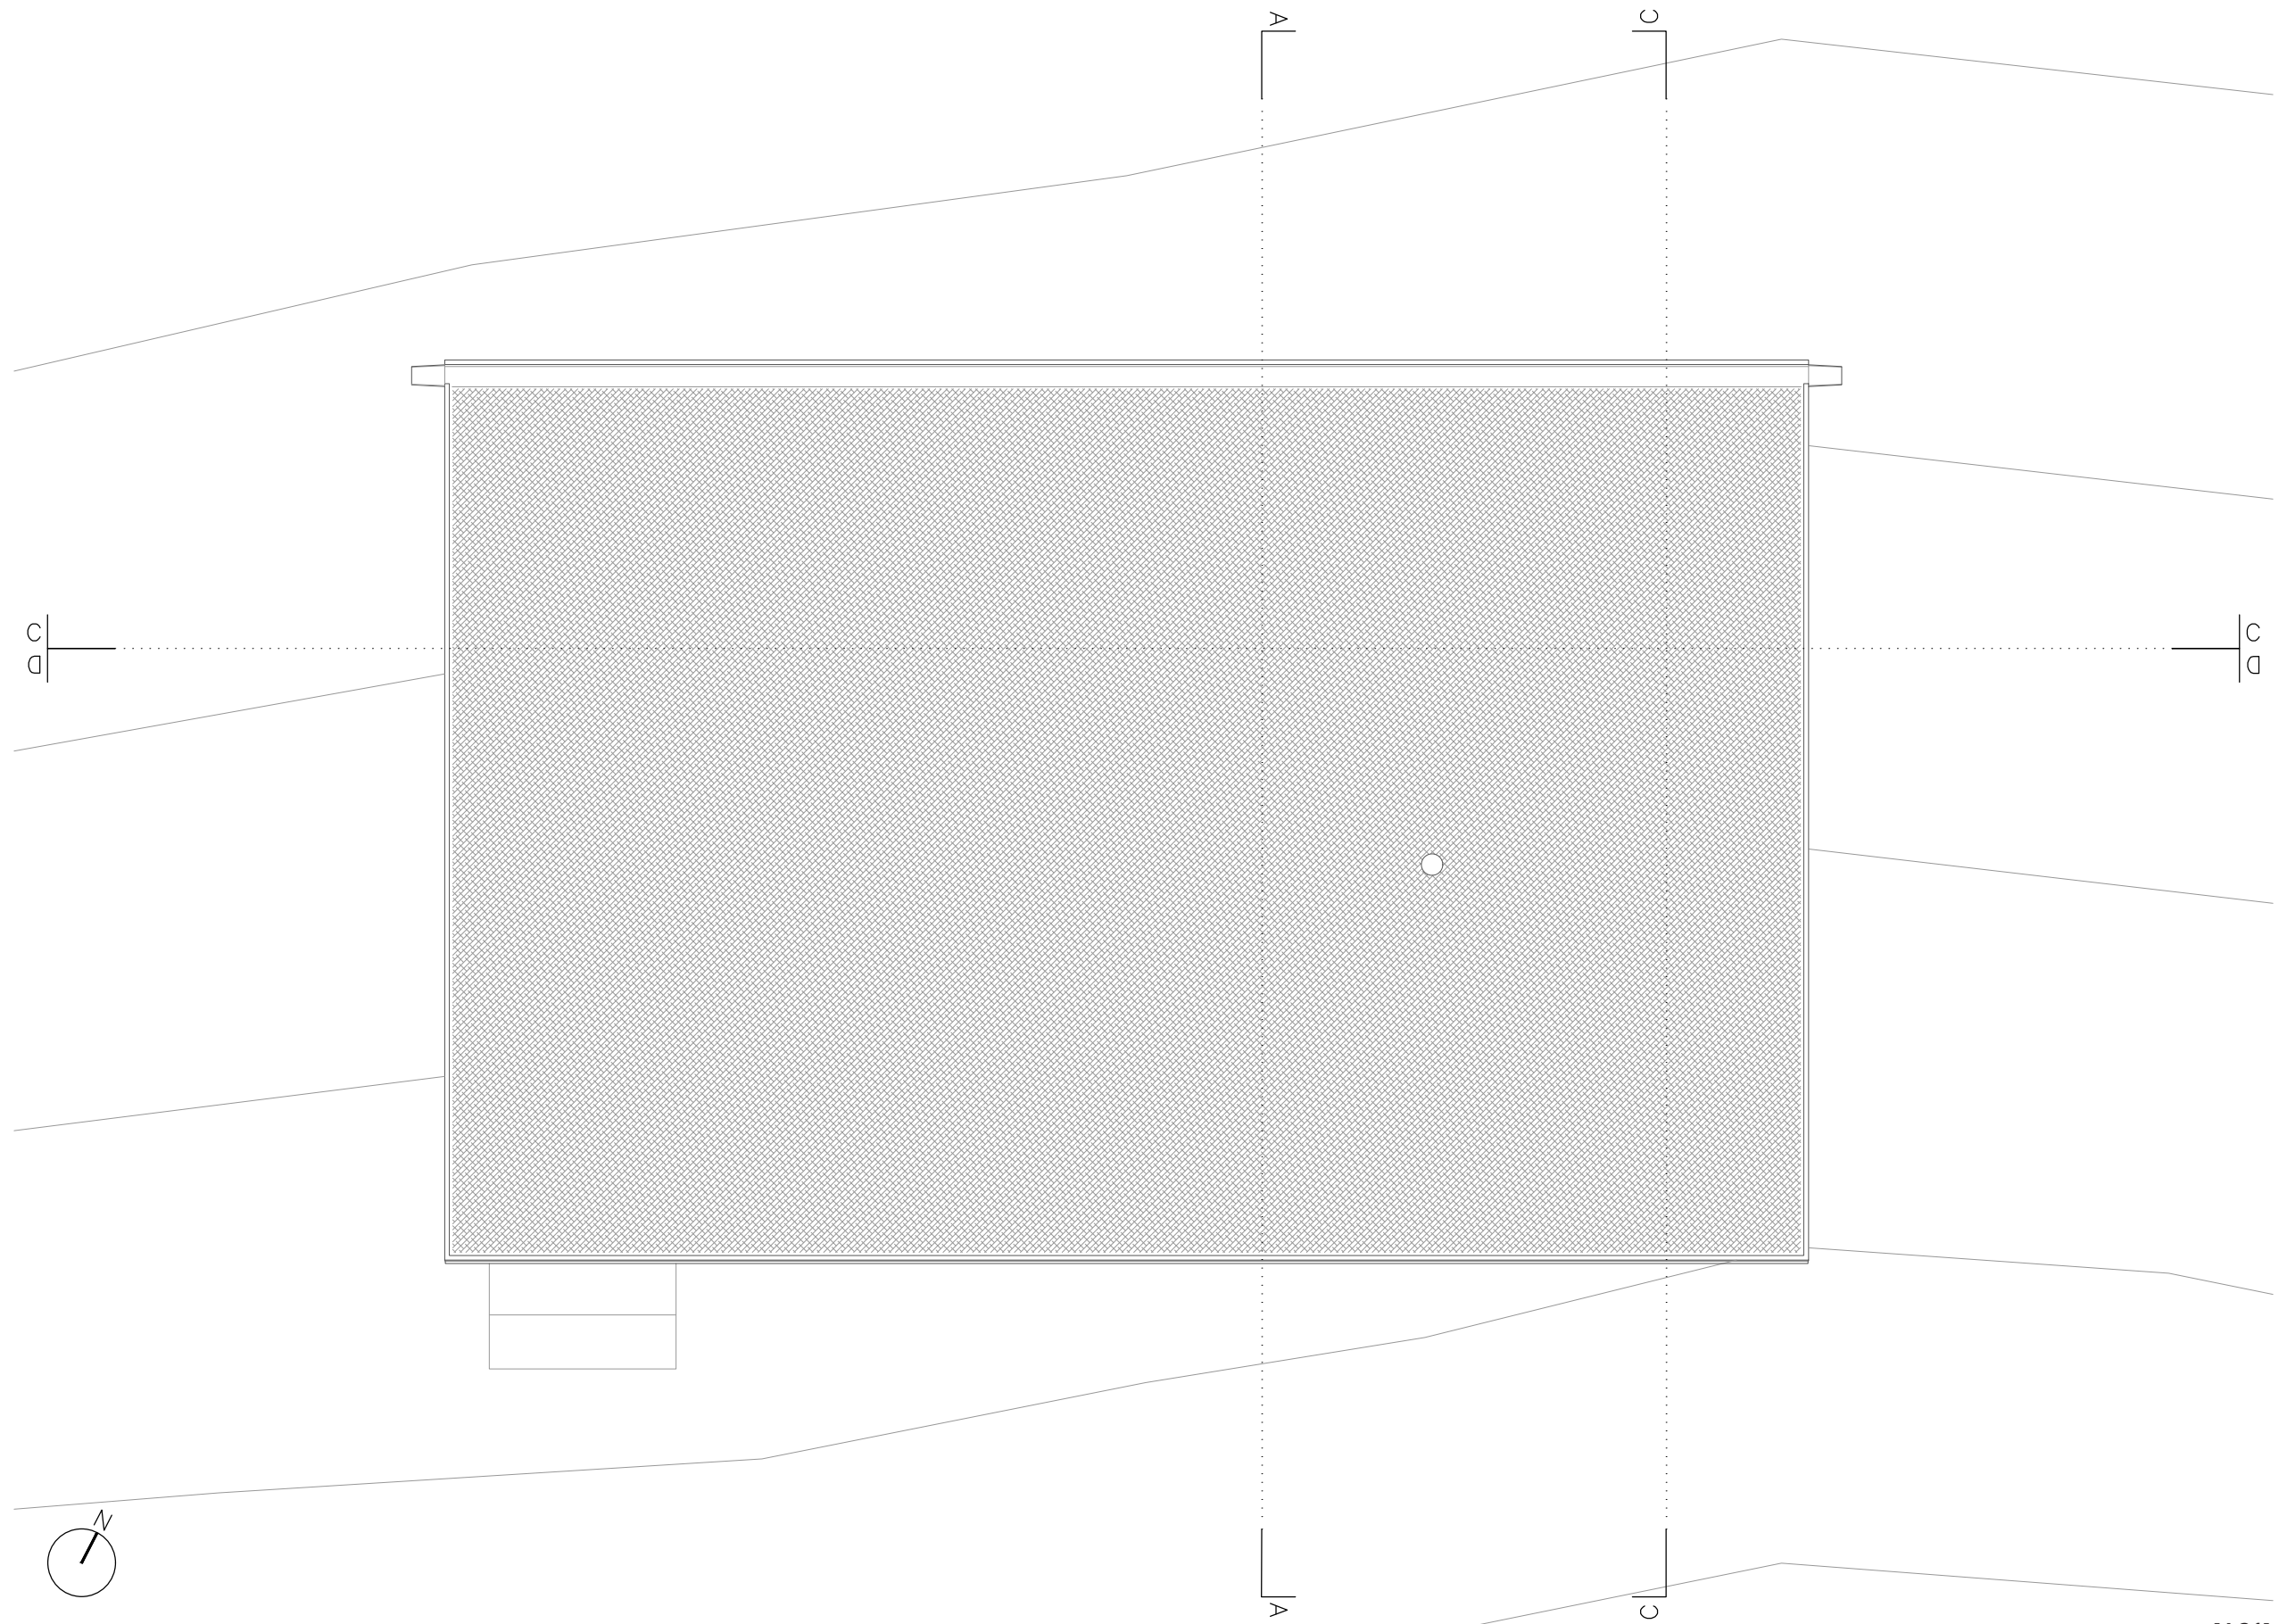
Abrigo Florestal - Planta Cobertura. Esc.1/50.
